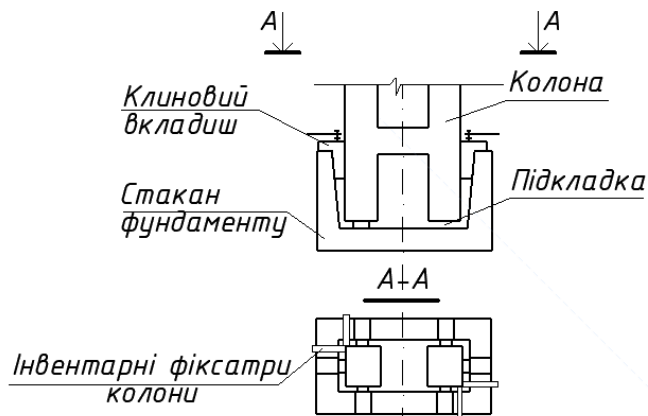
Спосіб стикування двогілкових колон з фундаментом
